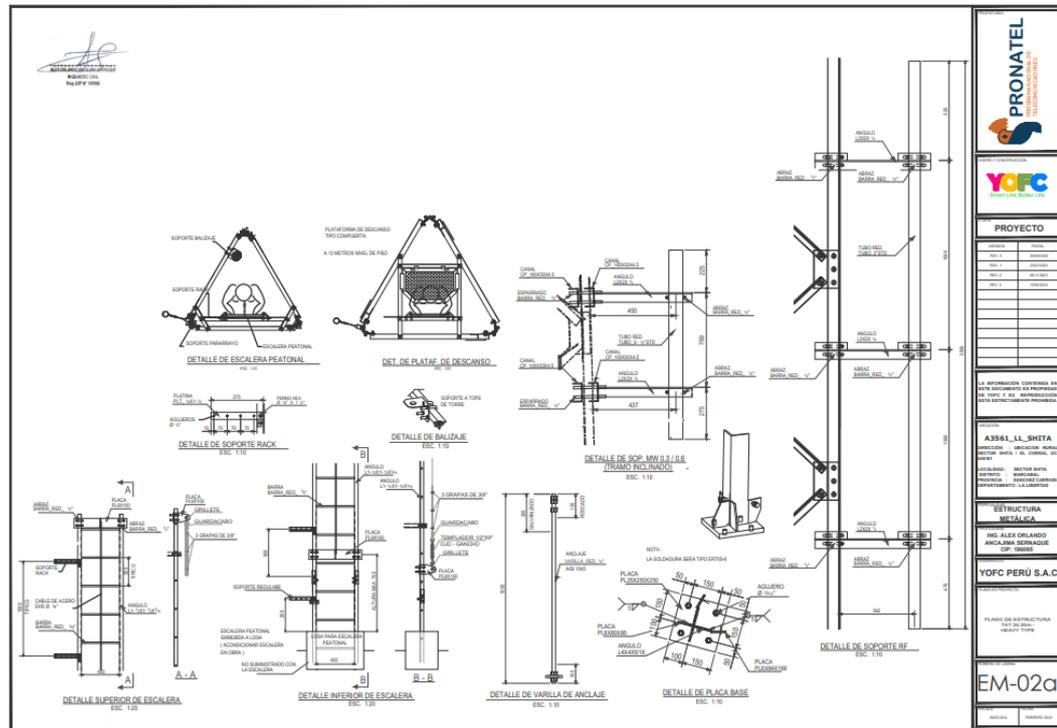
Plano de estructura metálica- A3561\_LL\_SHITA-02
